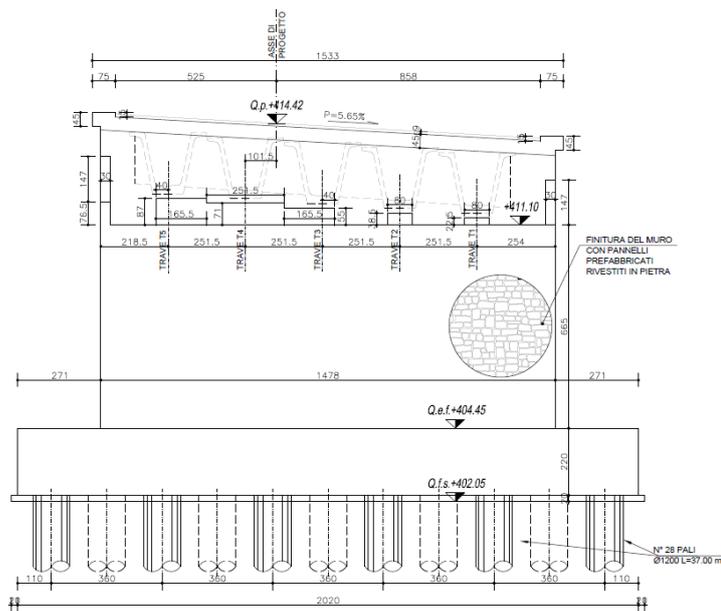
VISTA FRONTALE SPALLA SP2 VIADOTTO ASSINO 2
